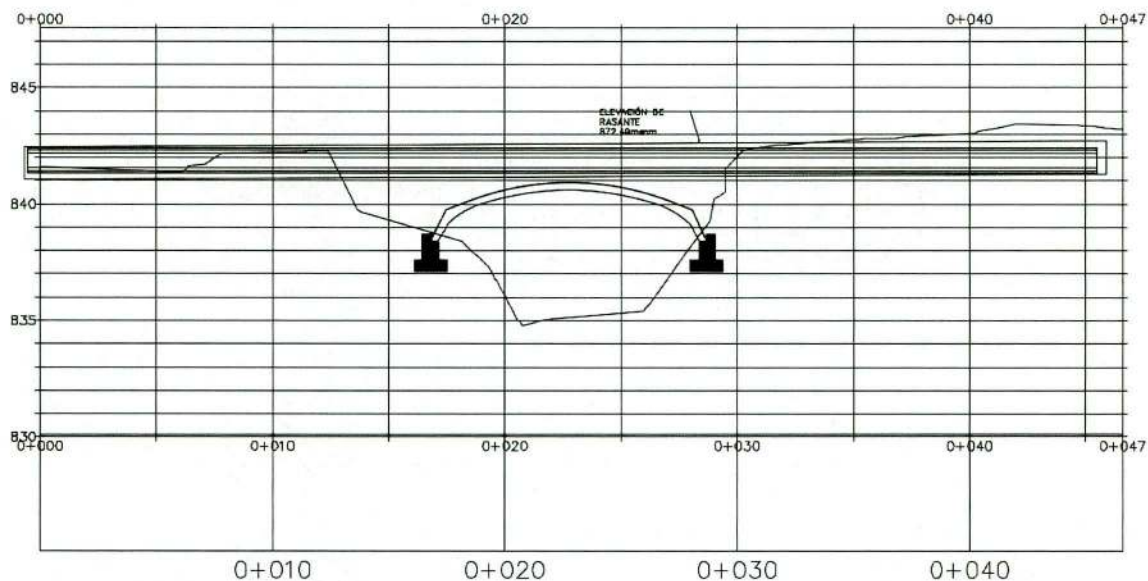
Sección transversal de la propuesta de alcantarilla de arco para el nuevo puente en el río Corrogres
